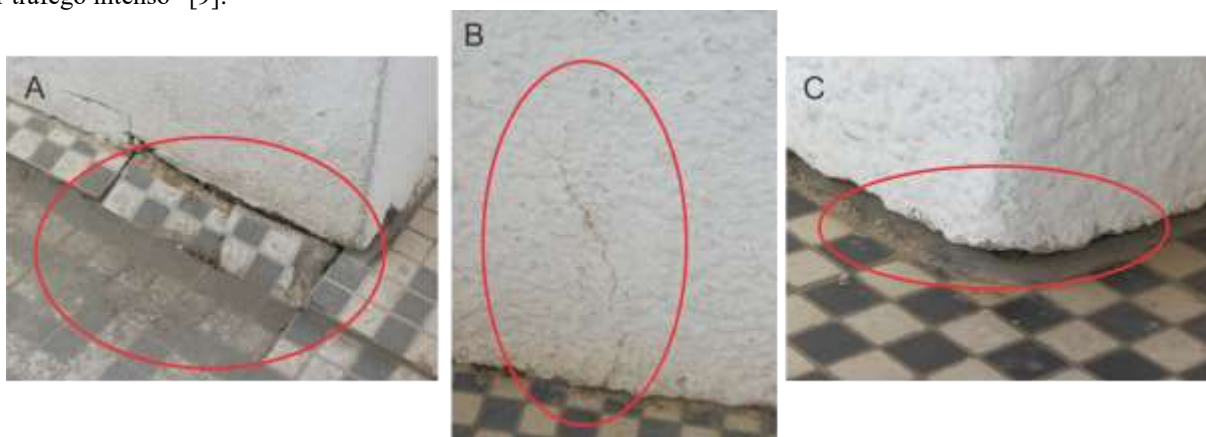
(A) Afundamento e trincas no piso, (B) Fissura vertical e (C) trinca entre piso e parede
